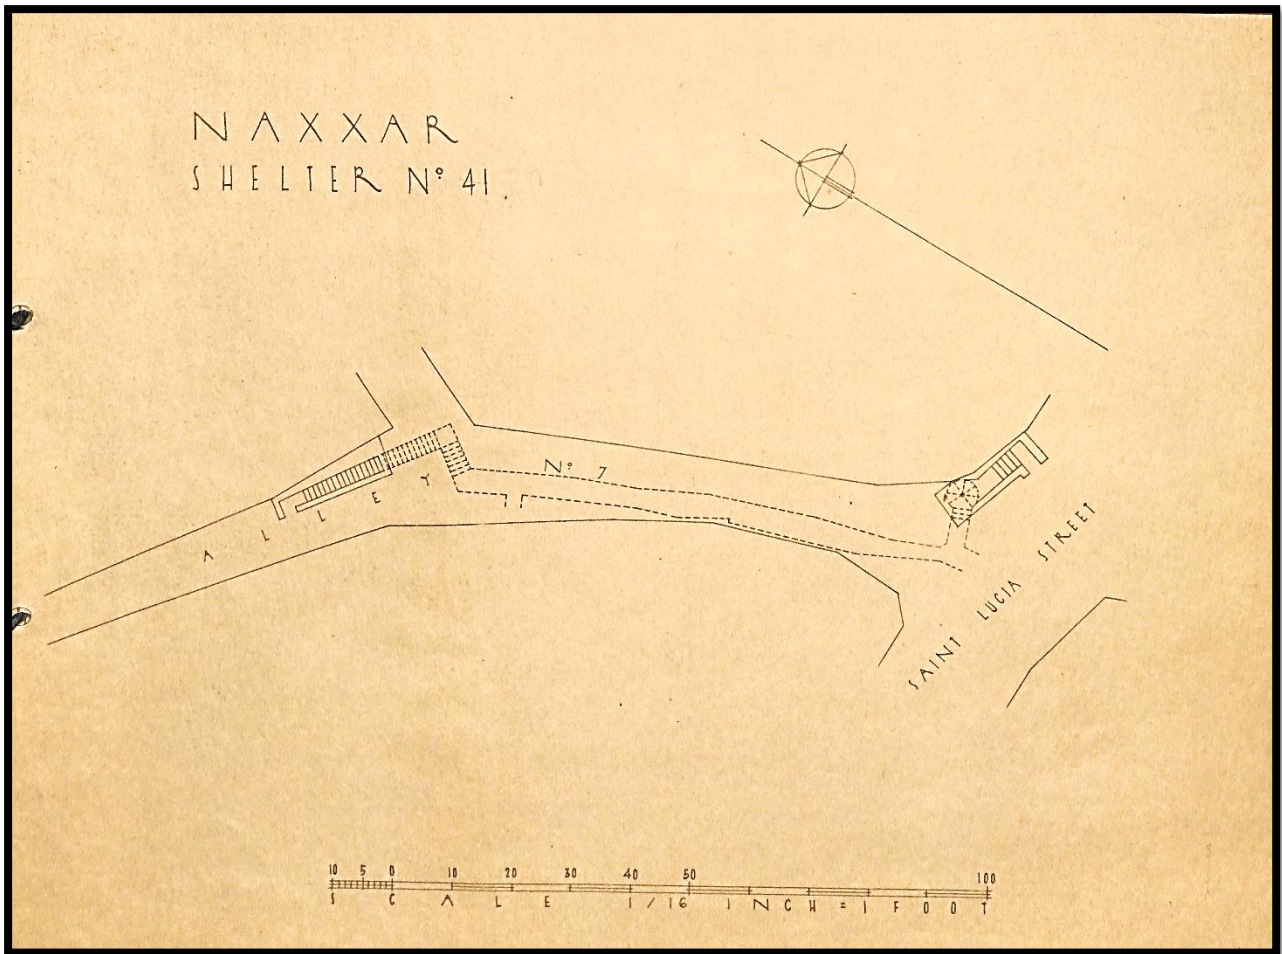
Planta do Abrigo nº41 (20) "Alley nº7 – Saint Lucia Street"
